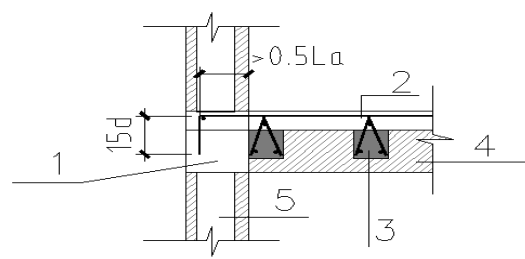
单向密肋叠合楼板墙体连接示意图
